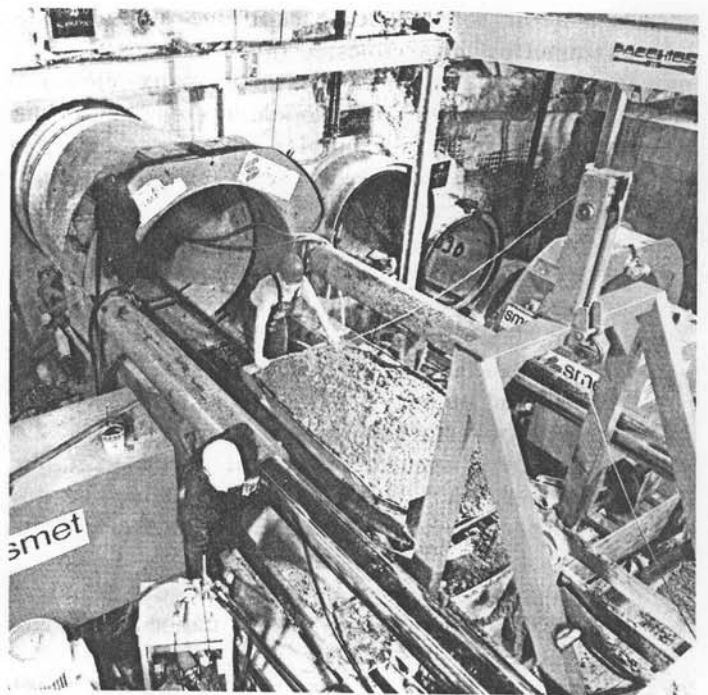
Station "Venezia" : puits de poussée et enfonçage des tuyaux.
